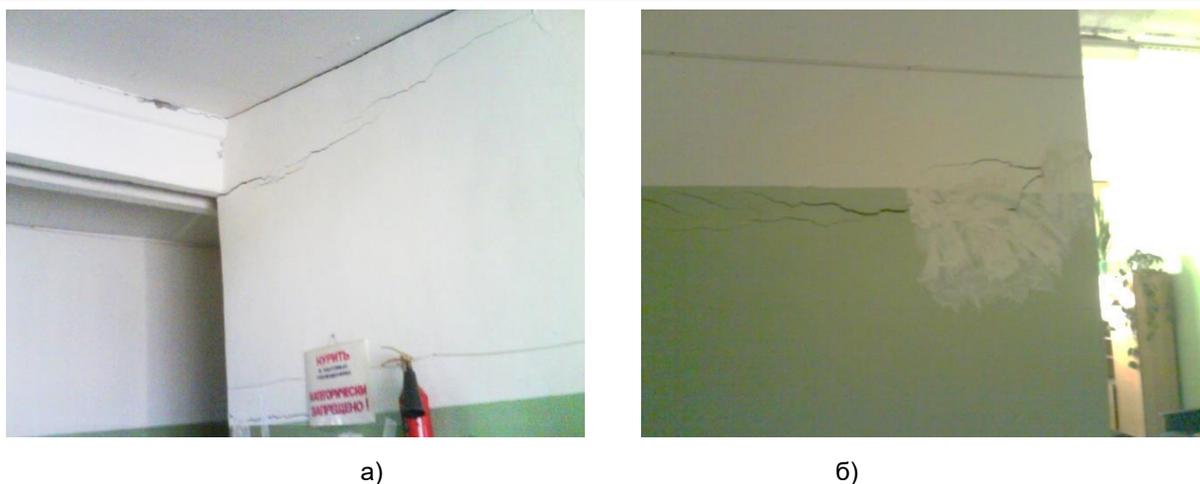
Горизонтальные трещины: а - в перегородке в осях «11-12»-«Б/1» на втором этаже в зоне аварийного столба; б - в перегородке в осях «11-12»-«Б/1» на втором этаже в зоне аварийного столба
